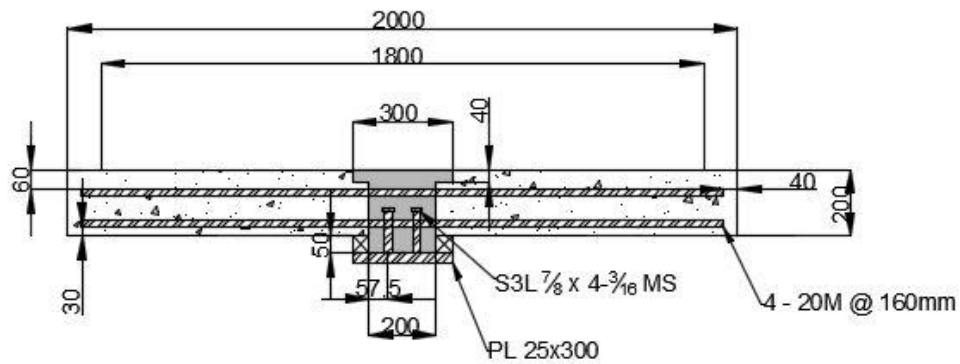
Vue en élévation typique du joint au niveau d'une poutre
